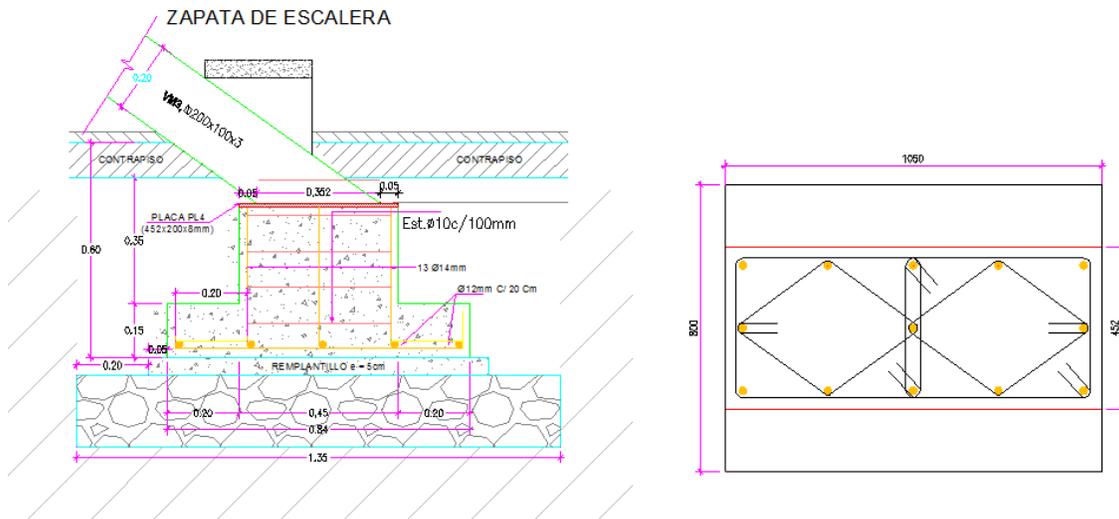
; Detalle de zapata de escalera para diseño de estructura metálica
